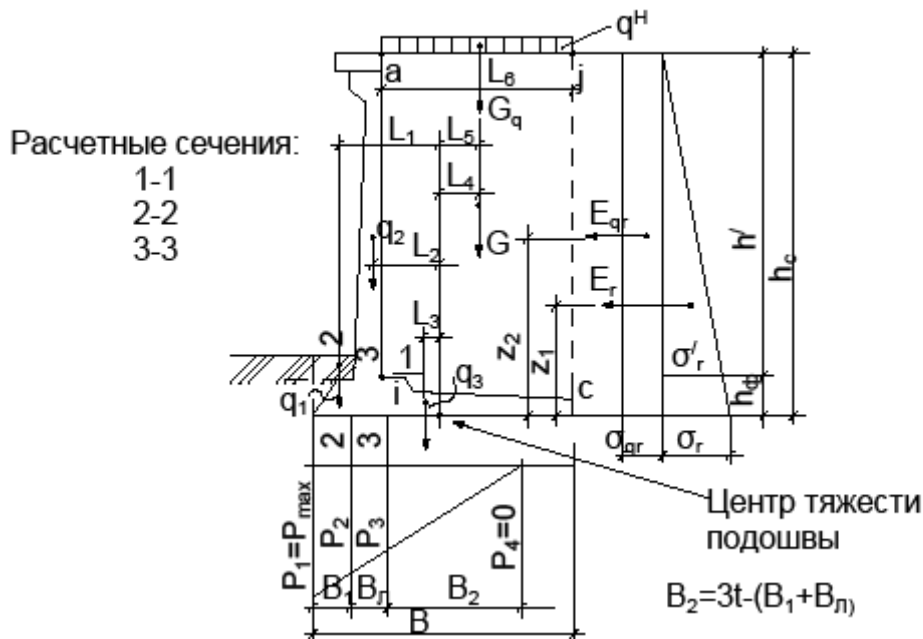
Расчетная схема угловой подпорной стены при расчете ее на прочность
